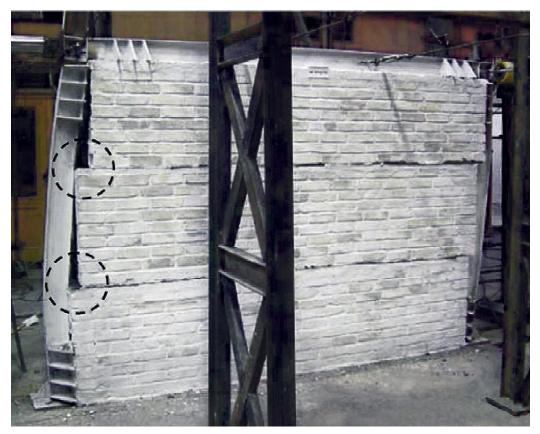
Setup di prova e meccanismo di rottura per un telaio tamponato in c.a. (Mohammadi e Akrami, 2010)(in basso).
